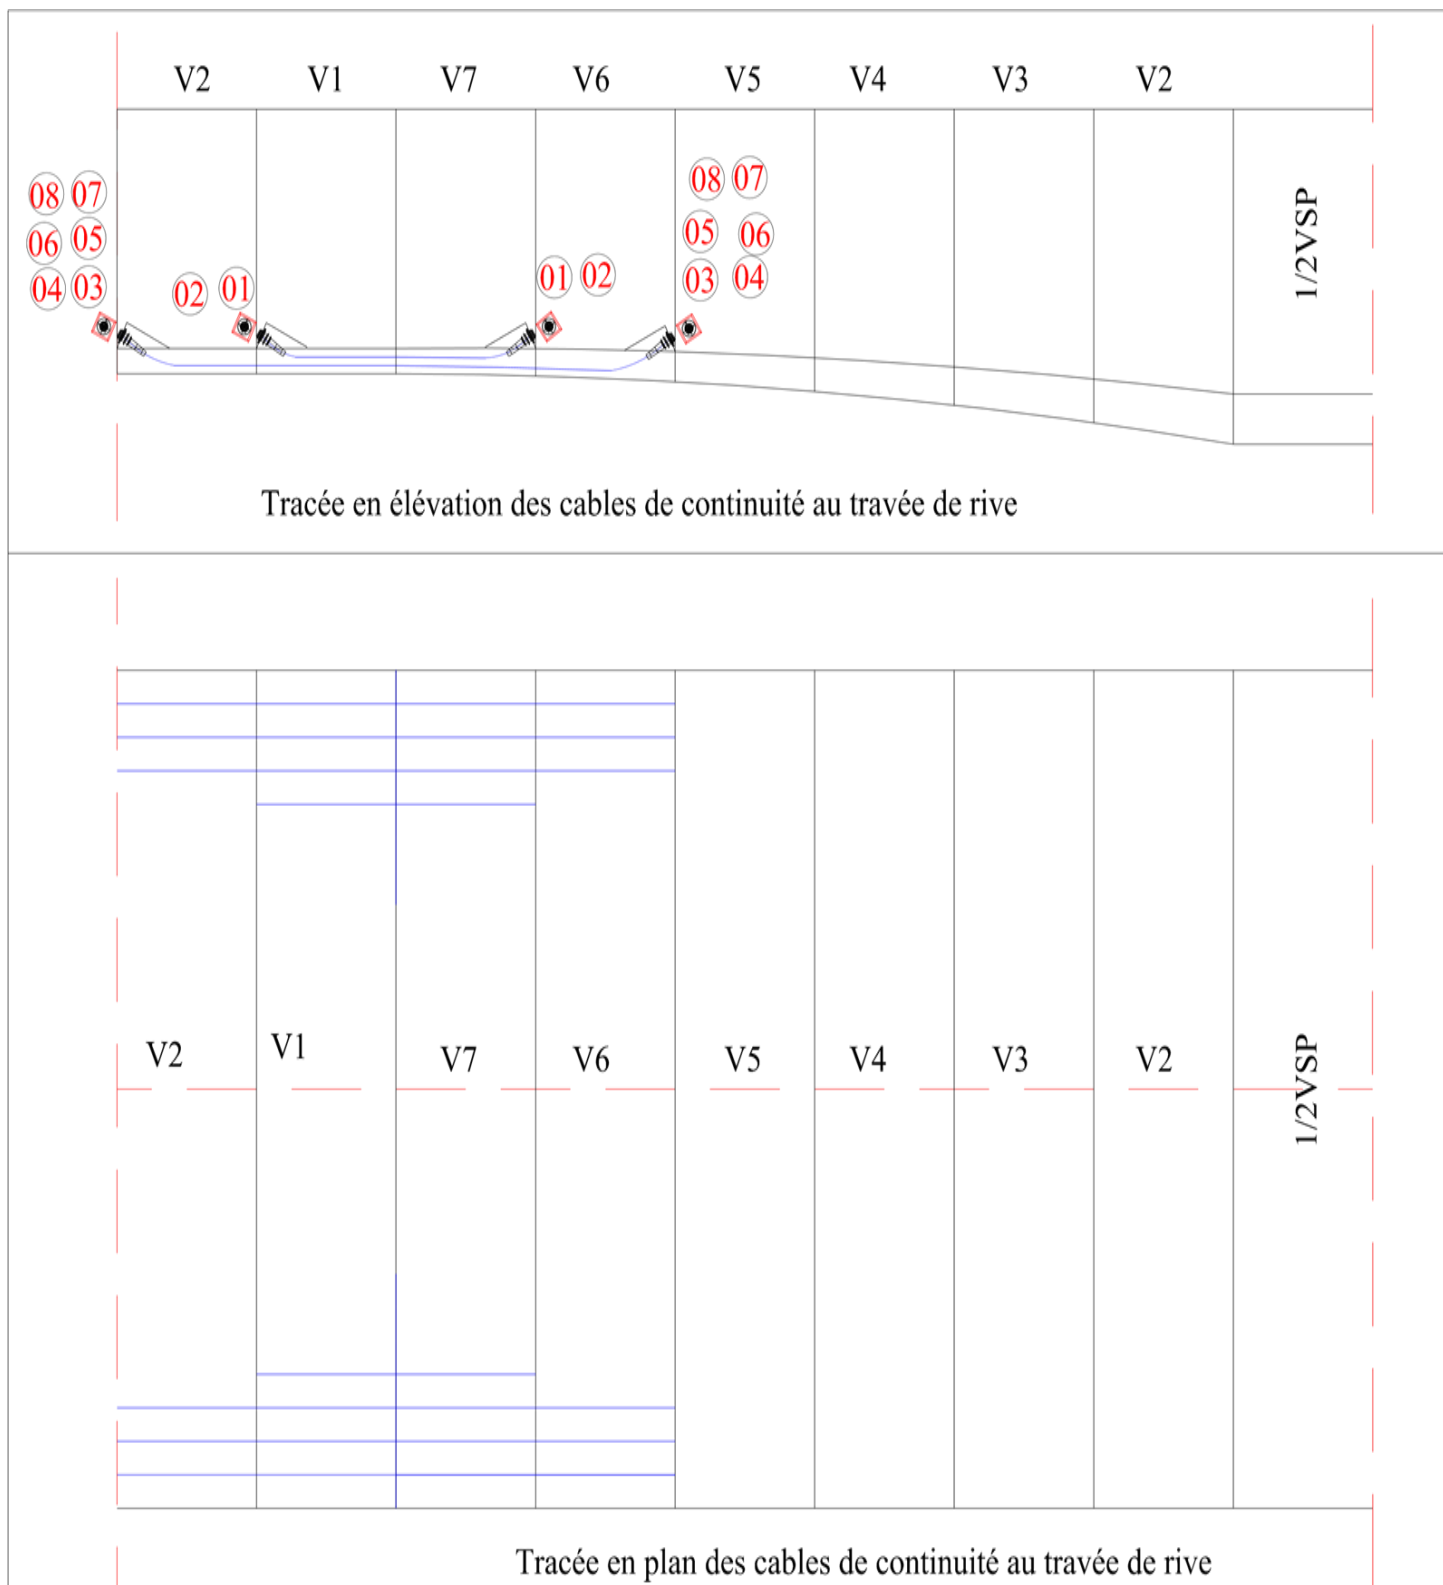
Vu en élévation et plan des câbles de continuité dans les voussoirs coulés sur cintre
